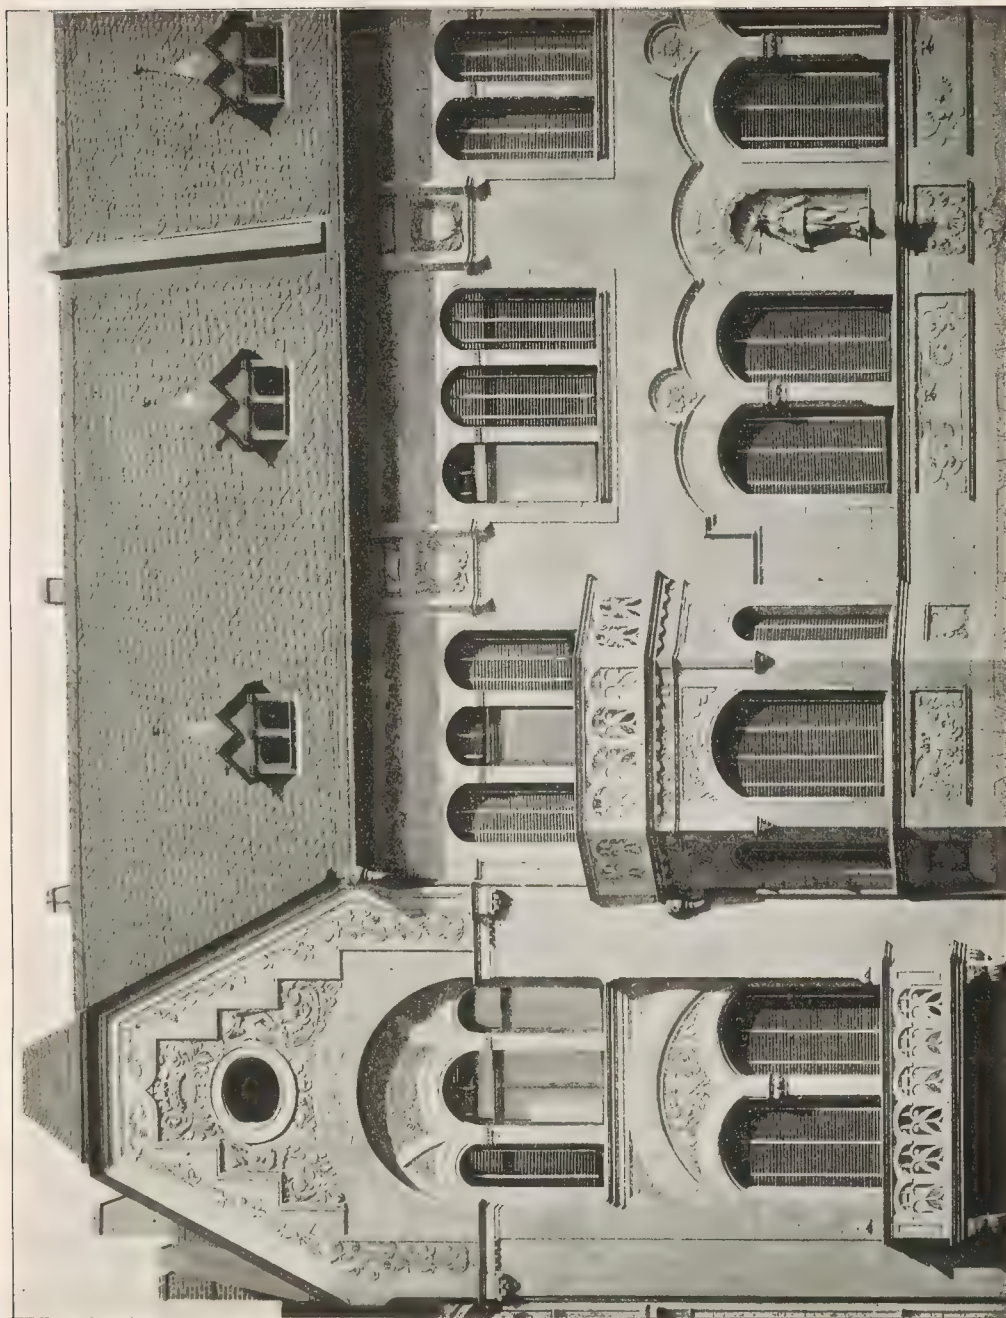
Architektur im Bild. Wohnhaus, Berlin, Bülowstraße 90/91. Architekten (remer & Wölffenstein.
